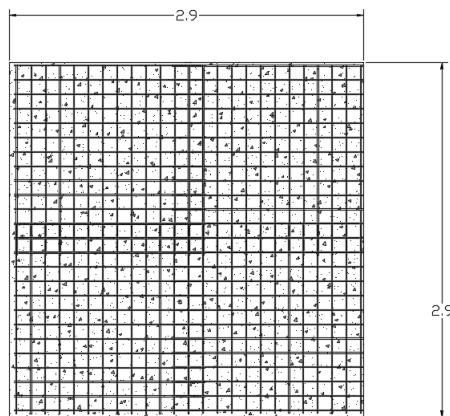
Vista de planta de la losa de termotanque y su armadura [m].
